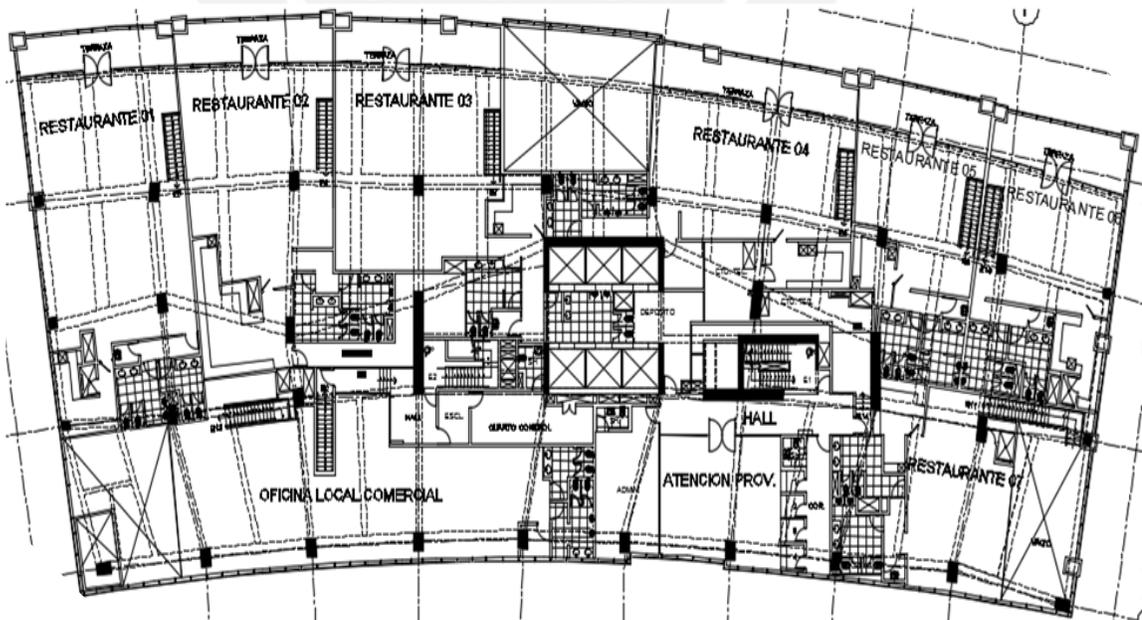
Plano de arquitectura del segundo piso – Edificio Anexo Torre 3
